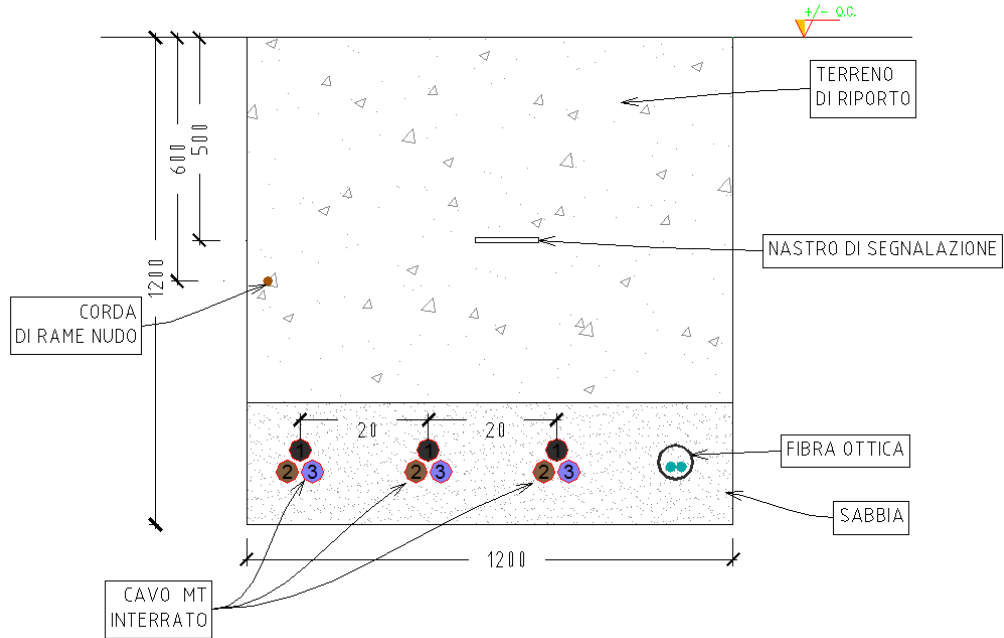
Sezione tipo posa cavo MT con n° 3 linee
